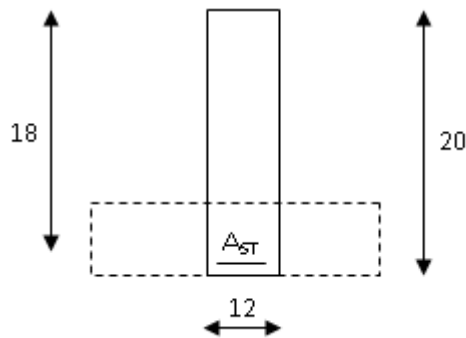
Section de calcul de la poutrelle aux appuis.
